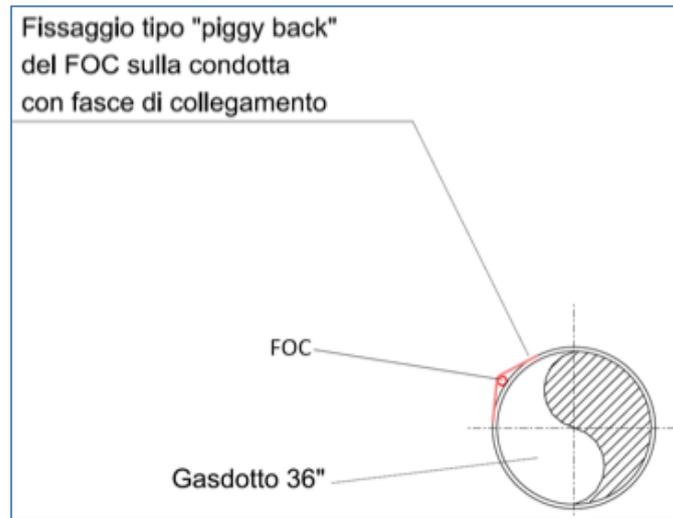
Esempio di installazione della FOC in modalità Piggy-back rispetto al gasdotto
